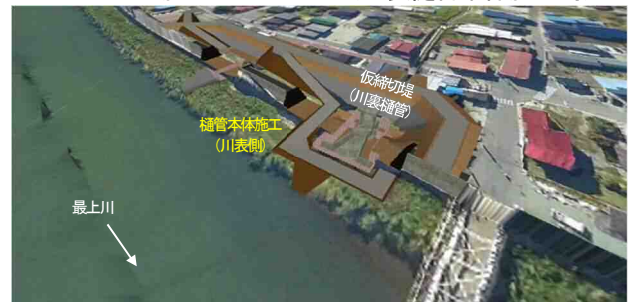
4D 施工ステップ図 (川表樋管本体施工時)
